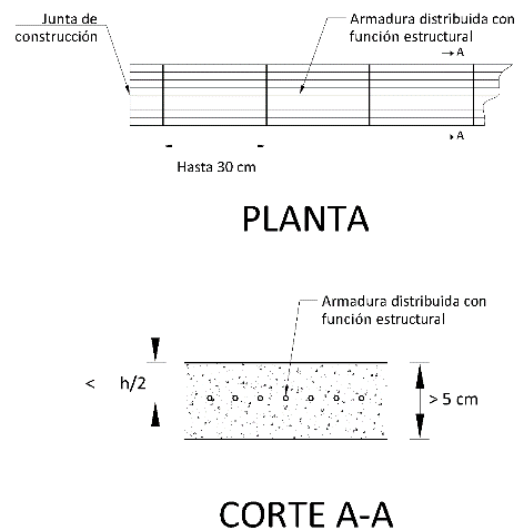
Pavimento de concreto hidráulico con refuerzo continuo.
